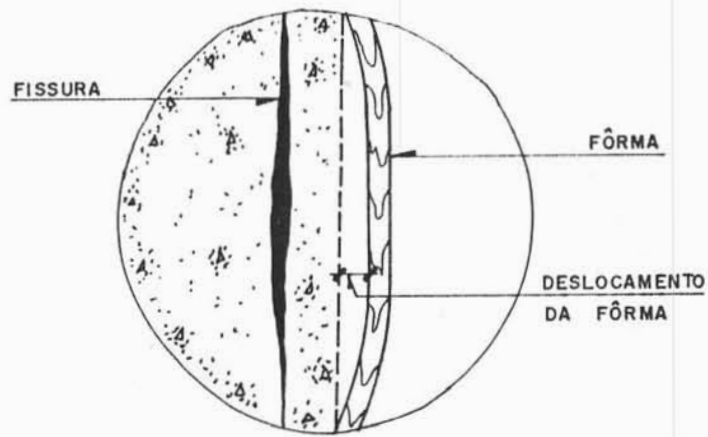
Fissura interna devido ao movimento da fôrma.
